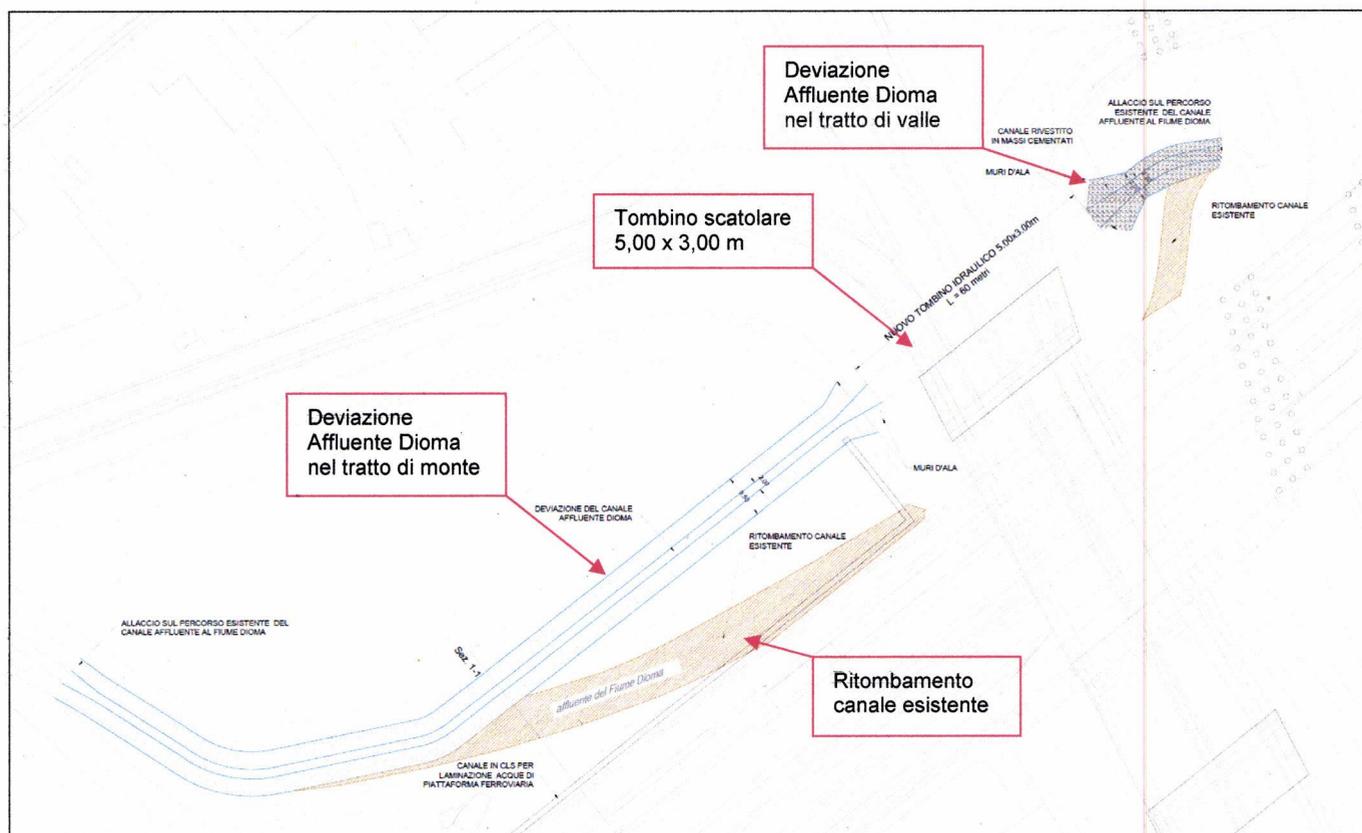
Stralcio planimetrico della sistemazione idraulica rogge affluenti della Dioma.
